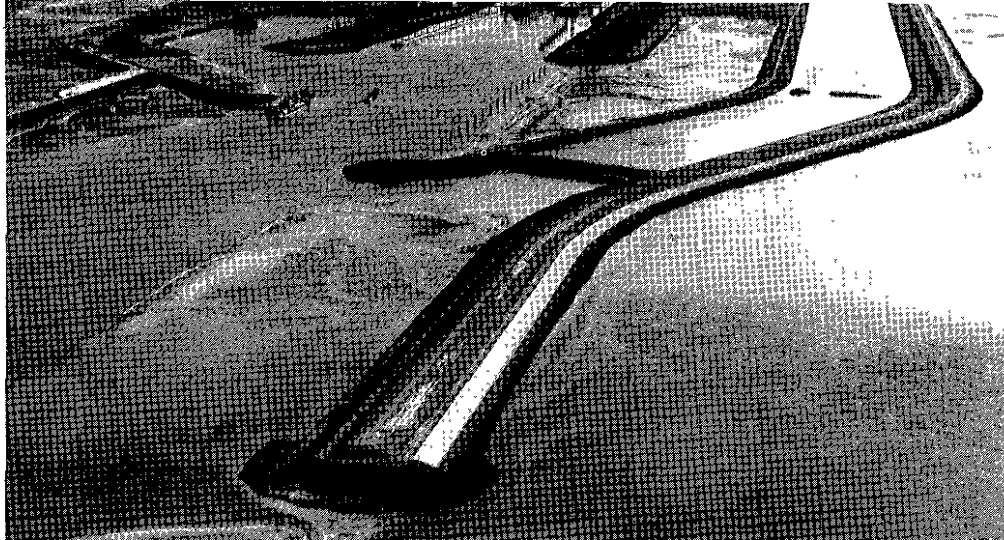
Met een betonband in de constructie kon uitspoeling van de klei worden tegengegaan
